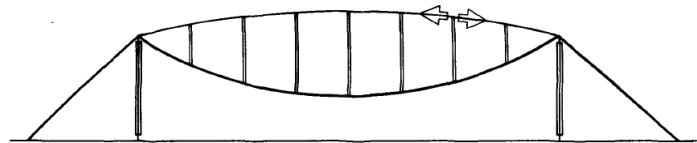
\_ Estabilización de la cubierta mediante un sistema secundario de cables
